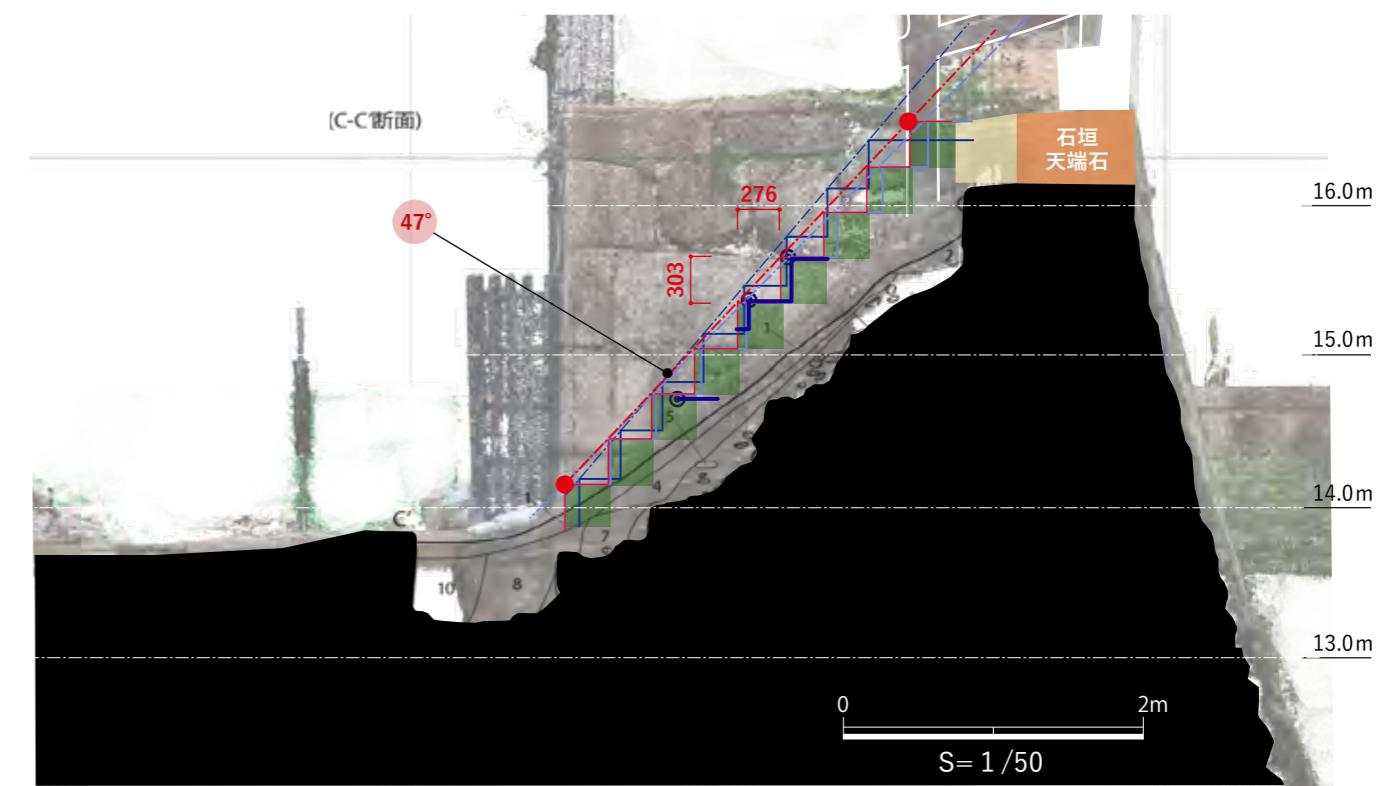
断面 C 断面図 + 立面陰影図 (見通し)
